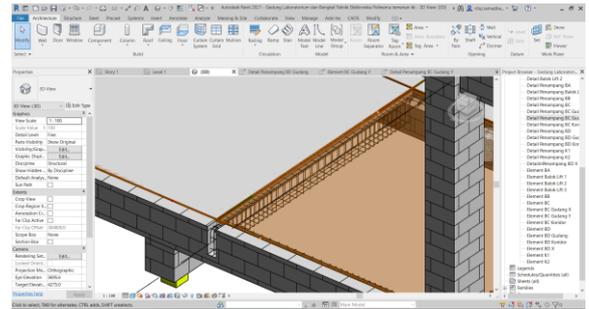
Tampilan Isometri Bangunan Pada Aplikasi Revit 2021
